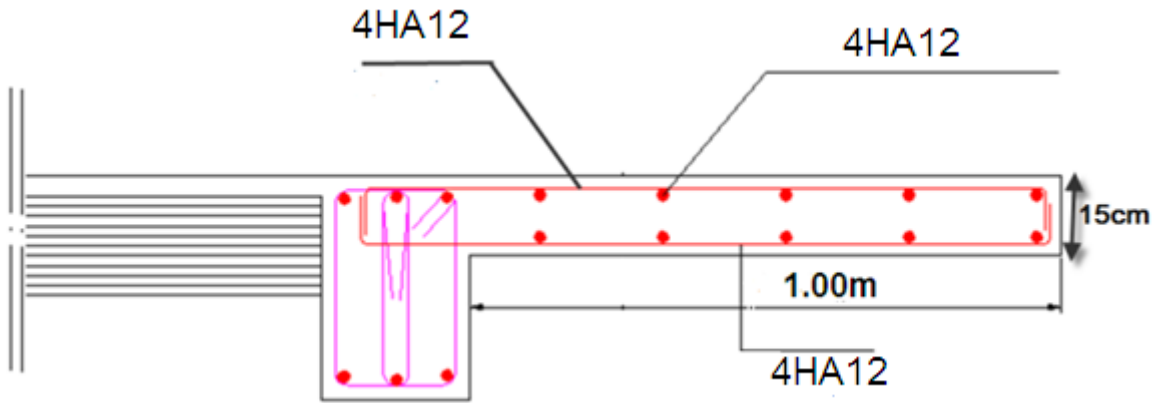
Schémas de ferrailage des Portes à faux
